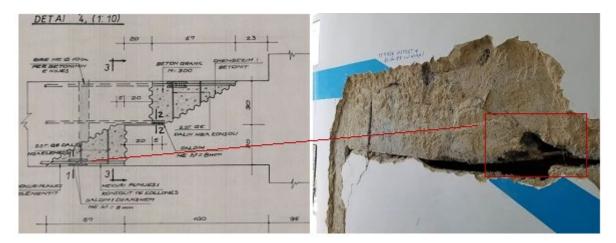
Beam connection detail used for the "Mother Teresa" hospital project (source: AQTN,1999; photo: Markel Baballëku).
